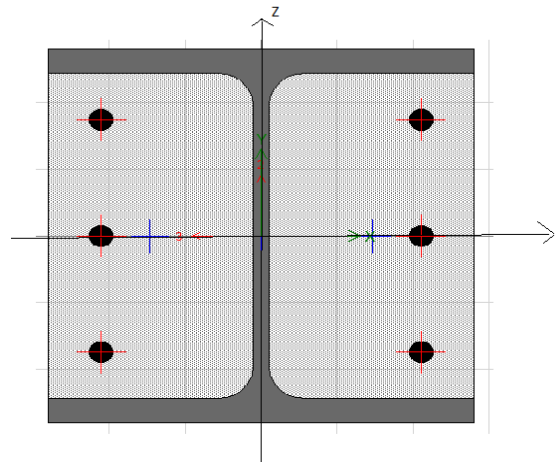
Section transversale d'un poteau mixte. [16]
